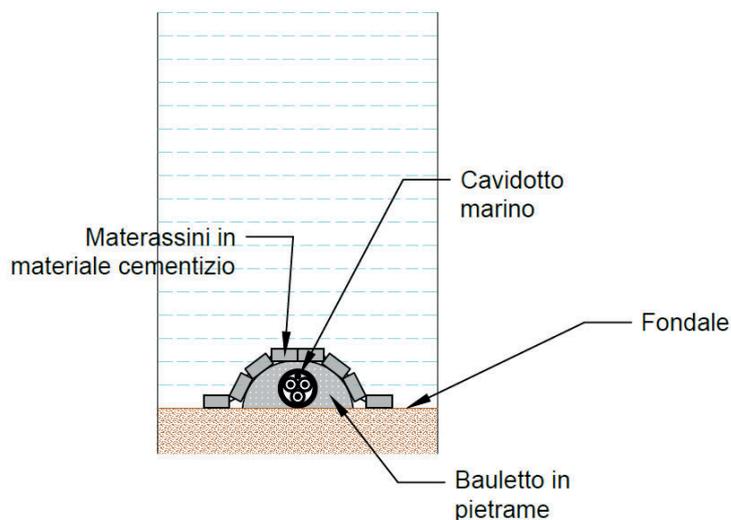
Sezione tipica di posa della linea in cavo su fondale marino
